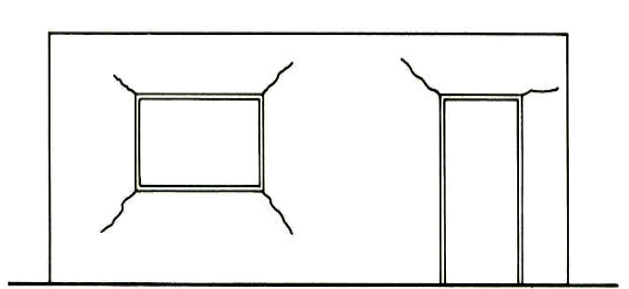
fissuração típica nos cantos das aberturas, sob atuação de sobrecargas (THOMAZ, 1989, p. 66)
